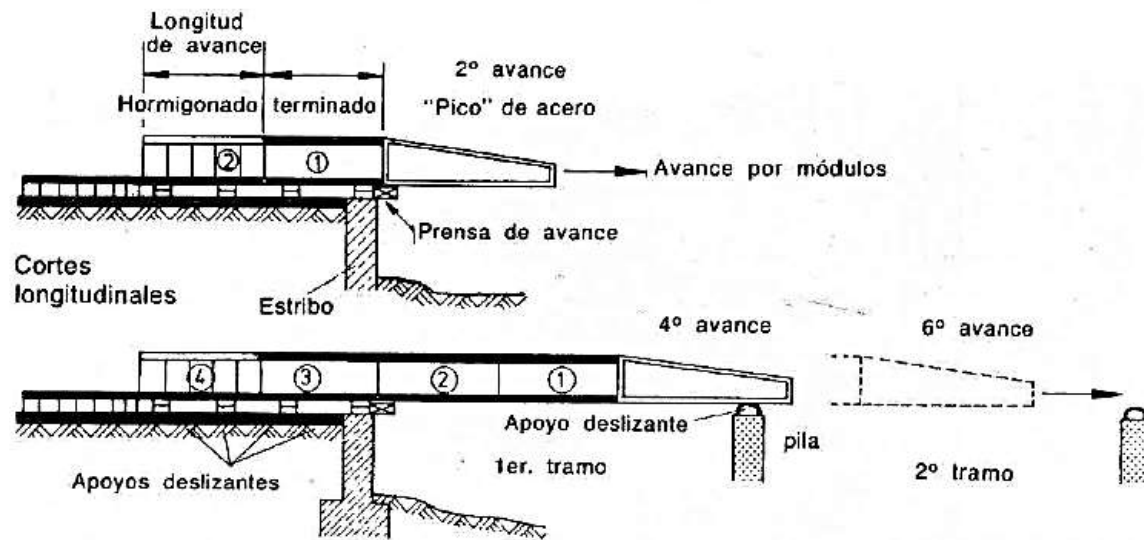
Principio del procedimiento de avance por módulos. Hormigonado por módulos detrás del estribo, se avanza libremente en voladizo, de pila a pila.
